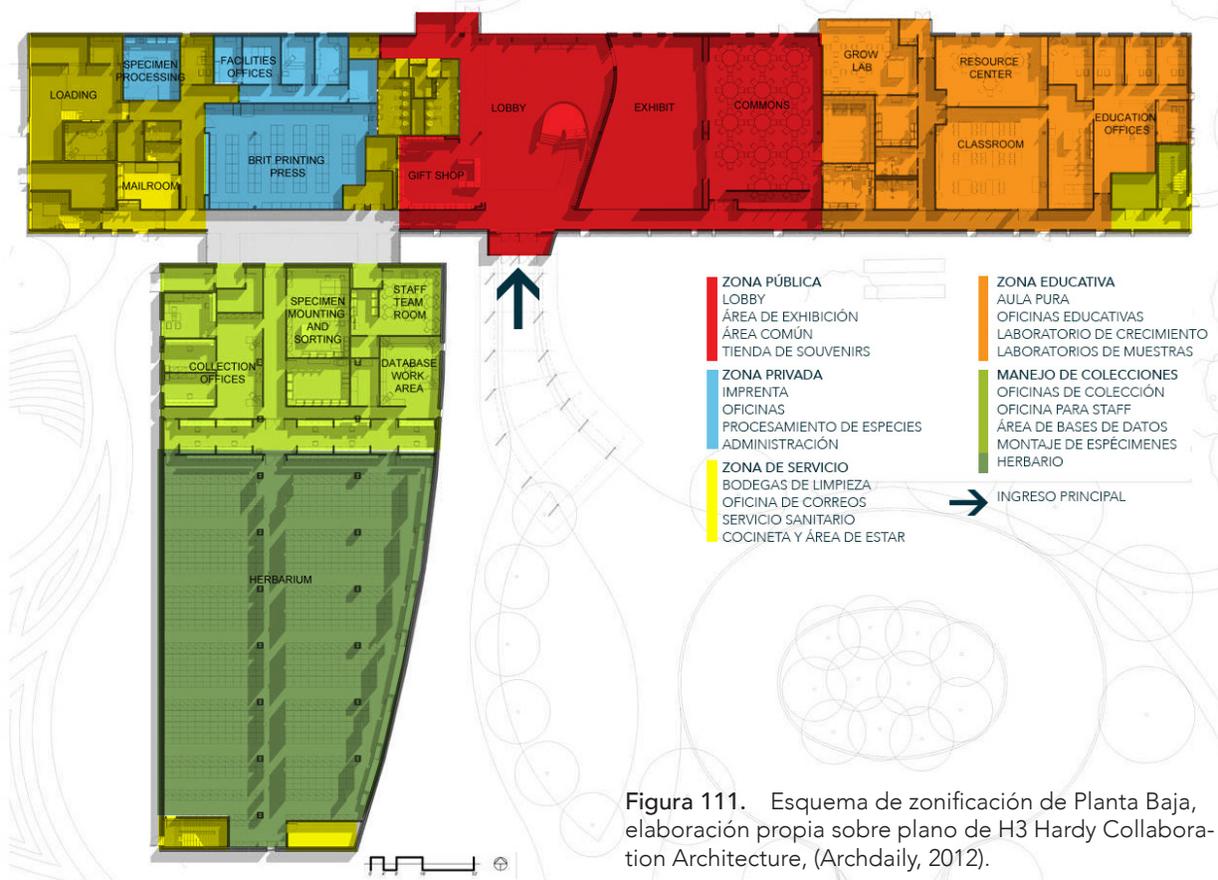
Esquema de zonificación de Planta Baja, elaboración propia sobre plano de H3 Hardy Collaboration Architecture, (Archdaily, 2012).
